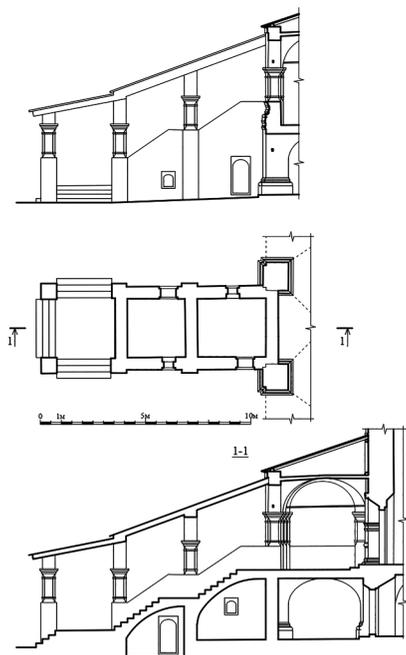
Графическая реконструкция западного крыльца Спасской церкви начала XVI в. Вариант 1. Фасад, план, продольный разрез
